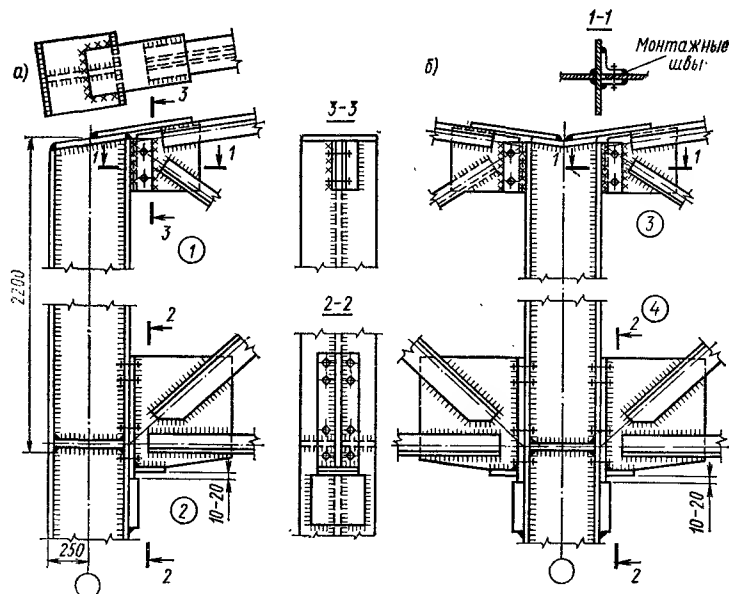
Опорные узлы (1—4) типовых унифицированных ферм с примыканием ферм к колонне сбоку
